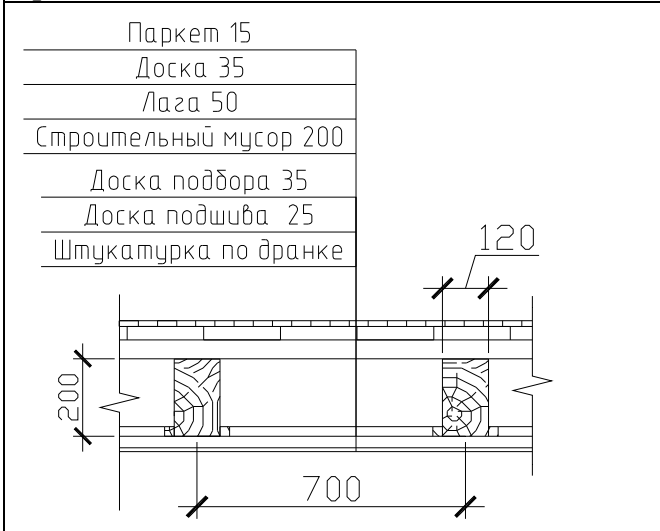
Перекрытие над третьим этажом в осях «8–11/А–Г»
